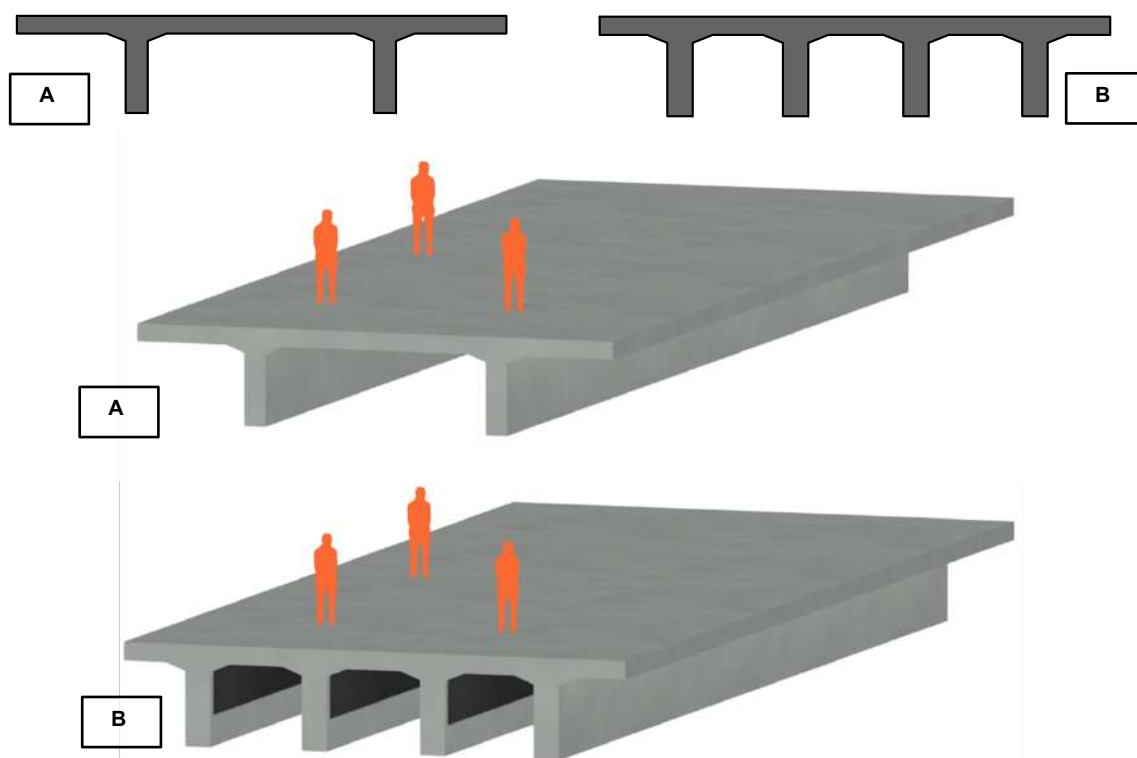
A. Duas longarinas moldadas em loco. B. Vigas múltiplas moldadas em loco. Fonte: autoral
